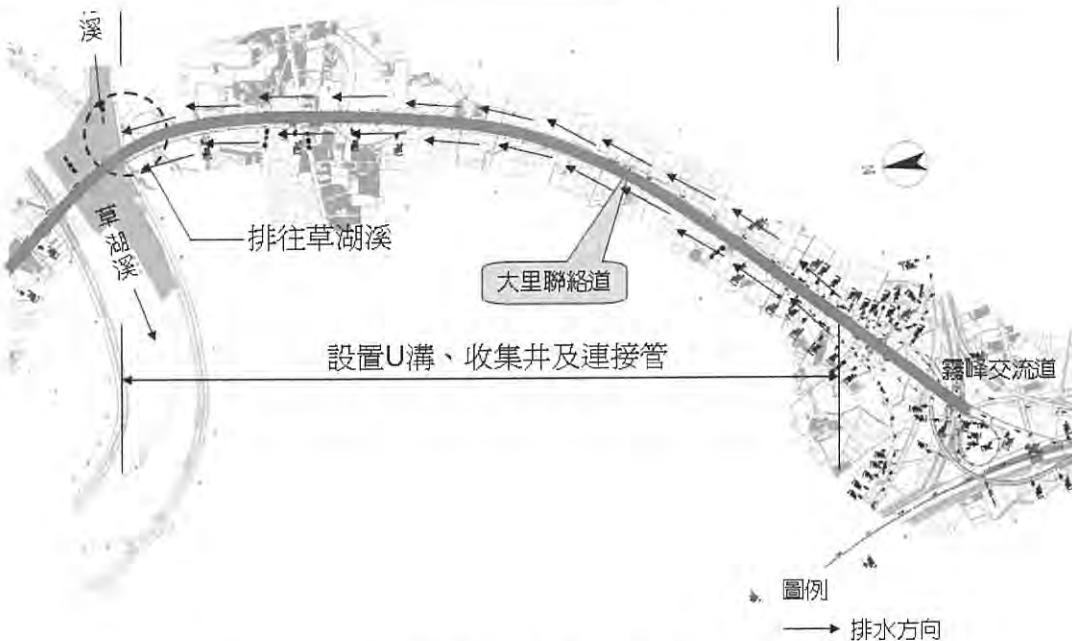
霧峰地區道路排水平面示意圖
